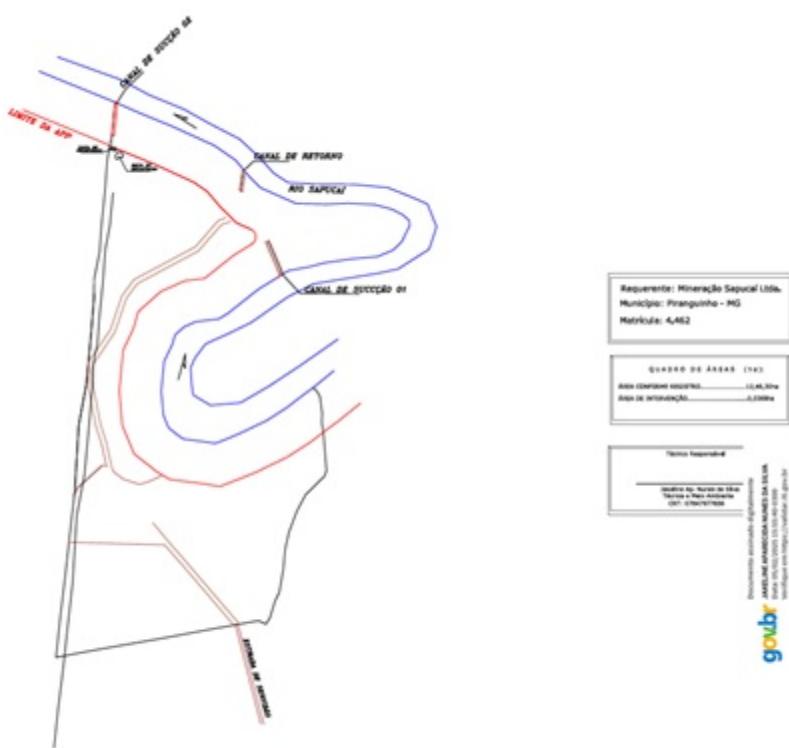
Planta de intervenção da cava do empreendimento Mineração Sapucaí. Fonte: Anexo SLA 2114/2025.
